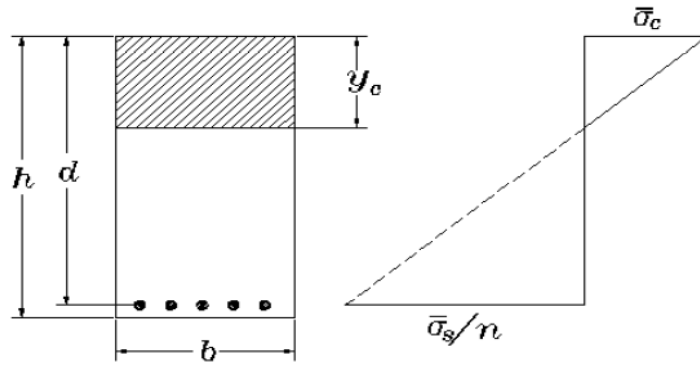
Tensioni indotte in una sezione in c.a. semplicemente inflessa
